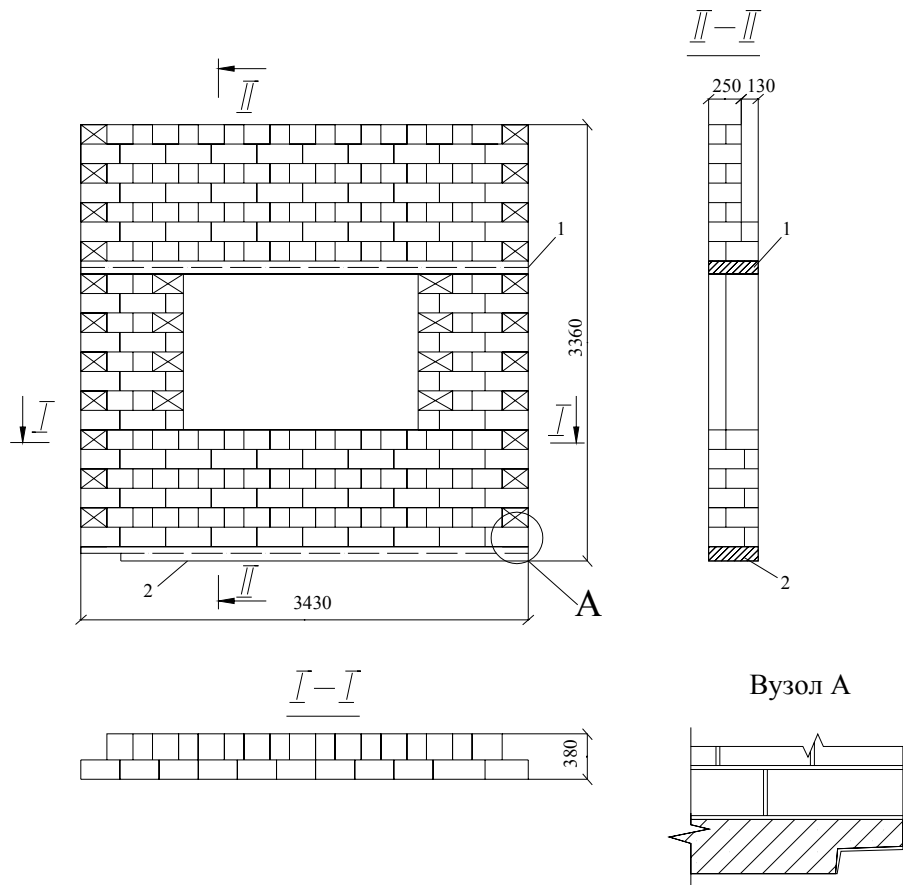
Стінова панель із керамічних каменів без вертикального армування:
